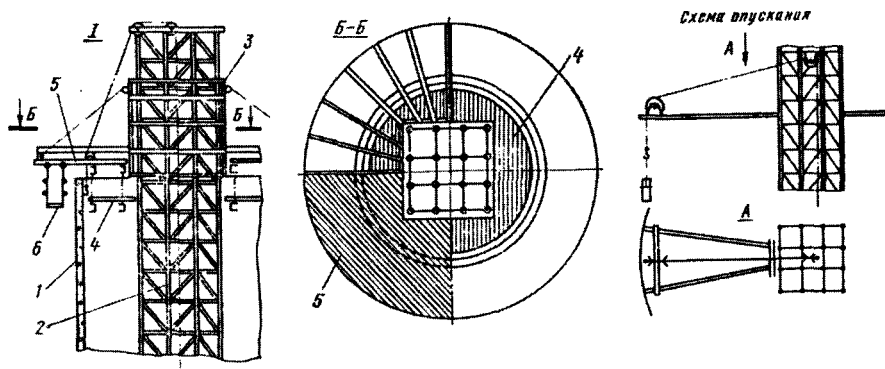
Схема установки механизмов при разборке железобетонного ствола трубы: 1 — ствол трубы; 2 — шахтоподъемник; 3 — подъемная головка; 4 — рабочая площадка; 5 — промежуточная площадка; 6 — подвесные леса
